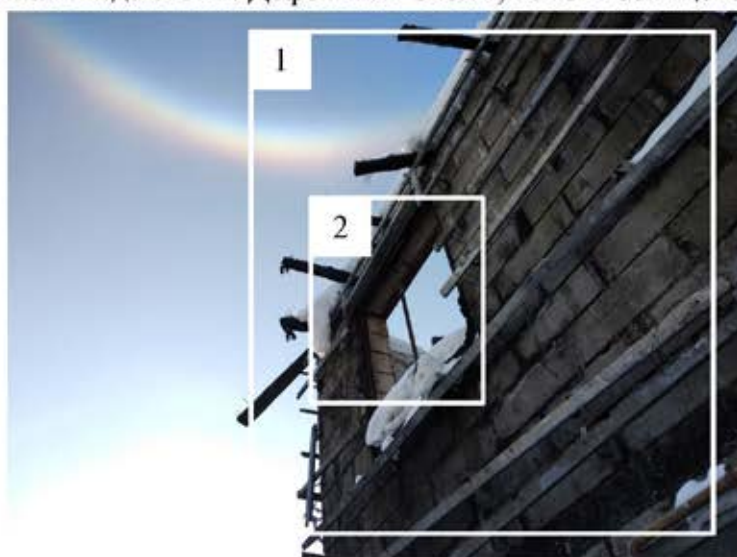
Фрагмент вида фасада. Дефекты: 1-повреждения навесного фасада, 2-повреждение оконного блока.
